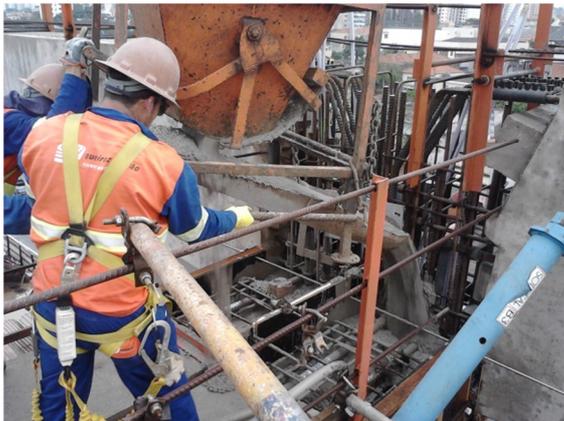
Concretagem da 1ª etapa de fechamento de apoios com junta de dilatação
